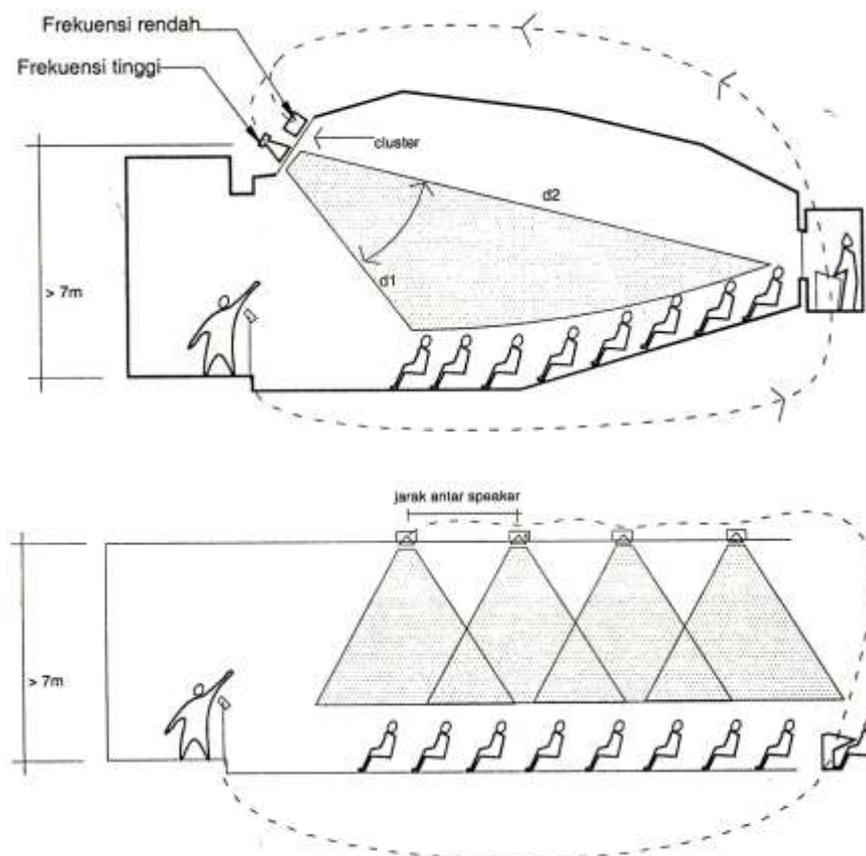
Hubungan Bentuk Ruang dengan penyebaran akustik
